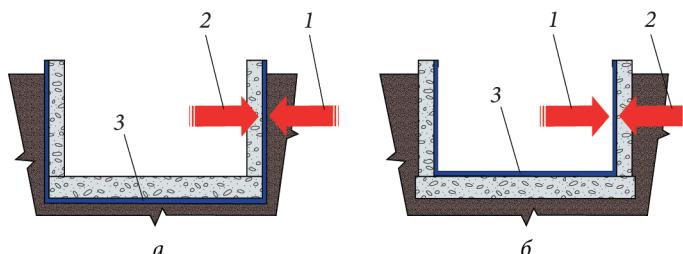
Положительное и отрицательное давление воды: *а* — наружная гидроизоляционная система; *б* — внутренняя гидроизоляционная система;
